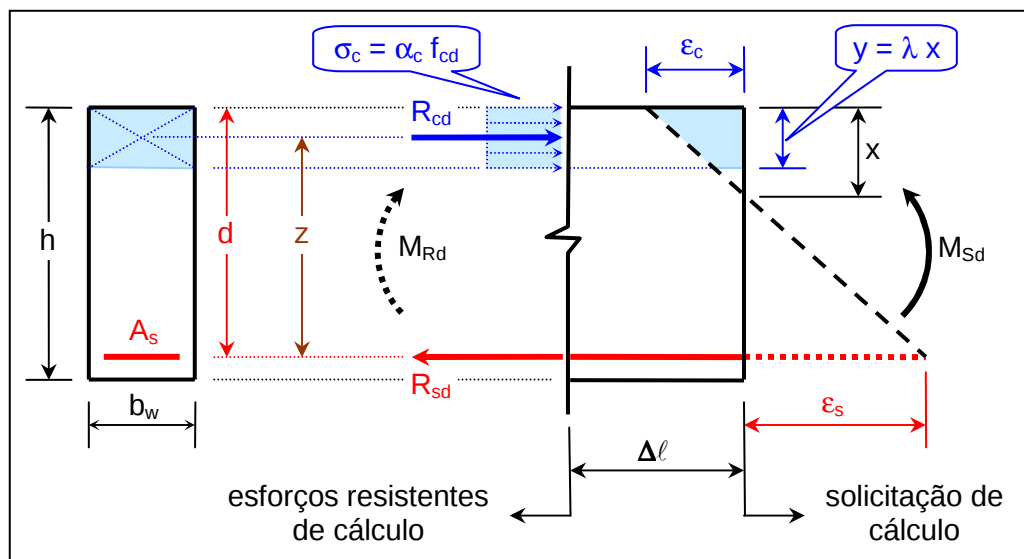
Viga de seção retangular sem armadura de compressão
